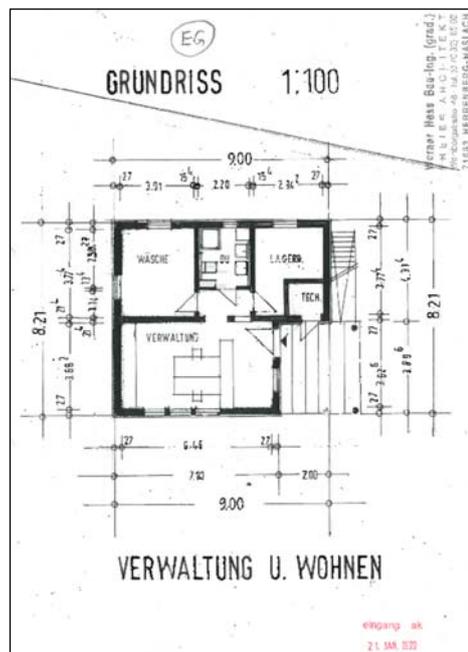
Grundriss EG – Verwaltung/Wohnen
